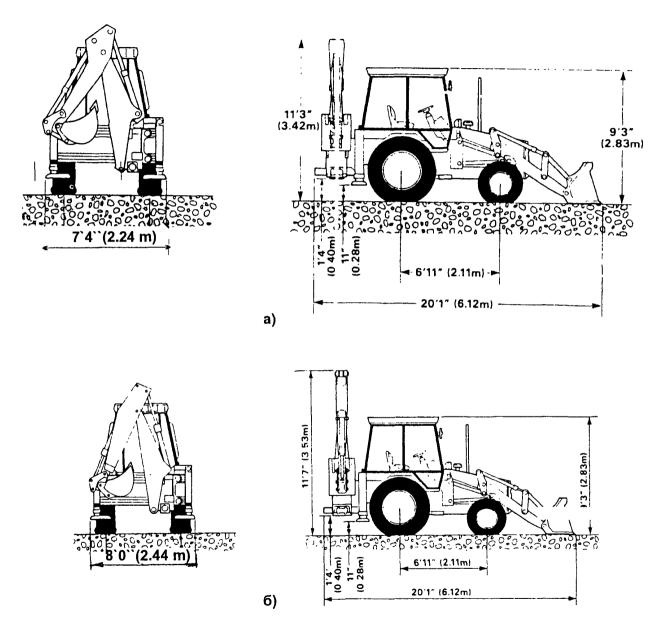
Неполноповоротный гидравлический экскаватор JCB - 3D: а) - стандартная рукоять; б) - телескопическая рукоять
